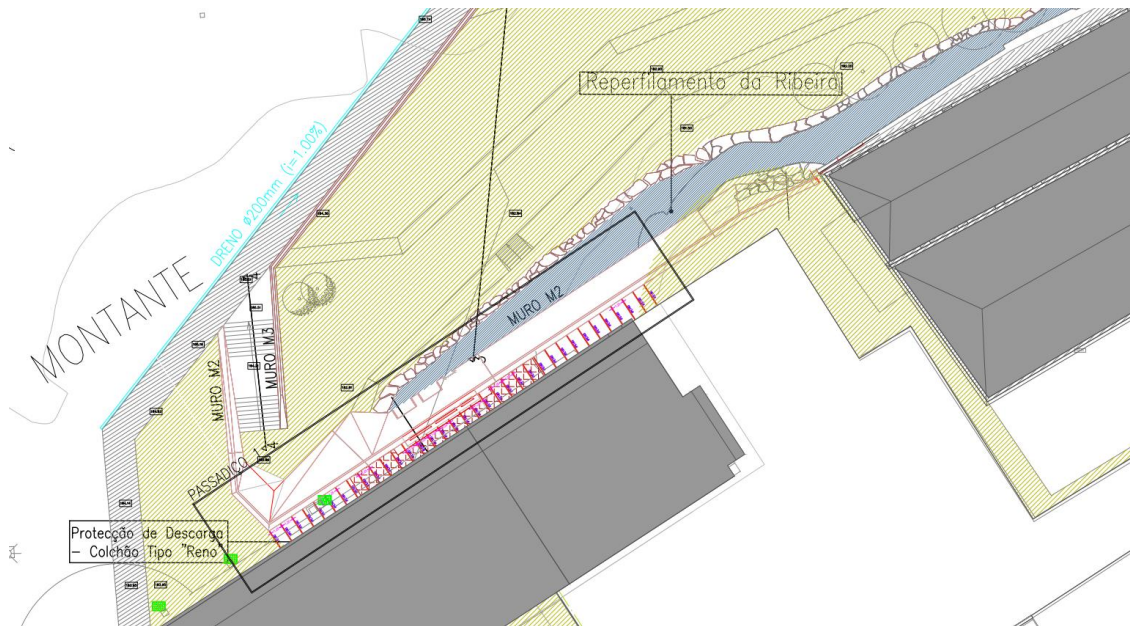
Plano de pormenor, a montante. Fonte: Projegui.
